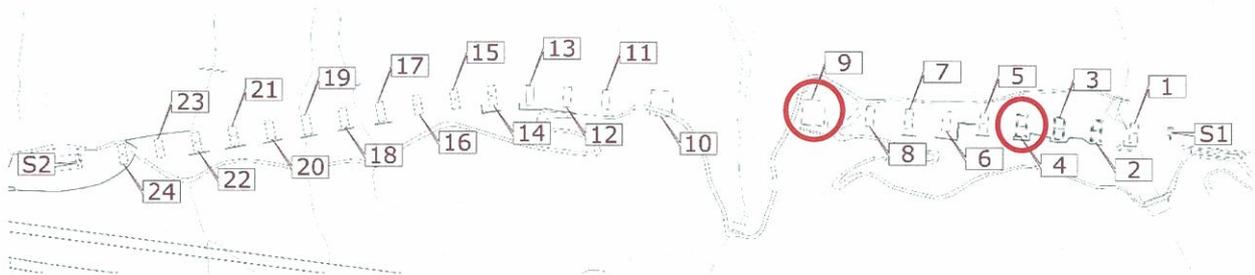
Stralcio planimetrico del viadotto Costaviola dismesso con indicazione delle opere oggetto delle analisi di stabilità.
